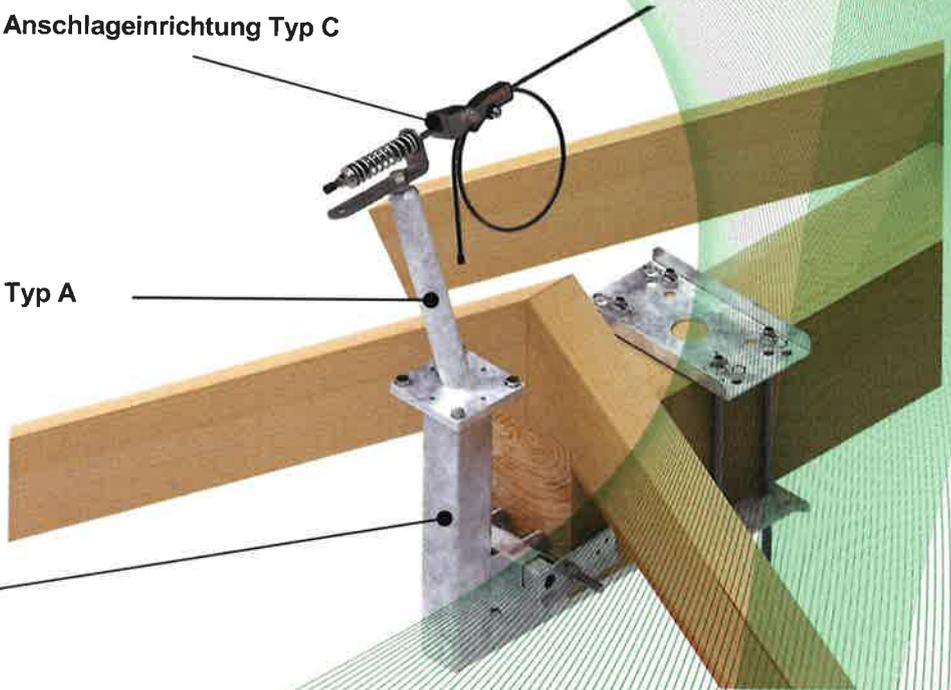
Anschlageinrichtung Typ C, Typ: AIO-TFS
